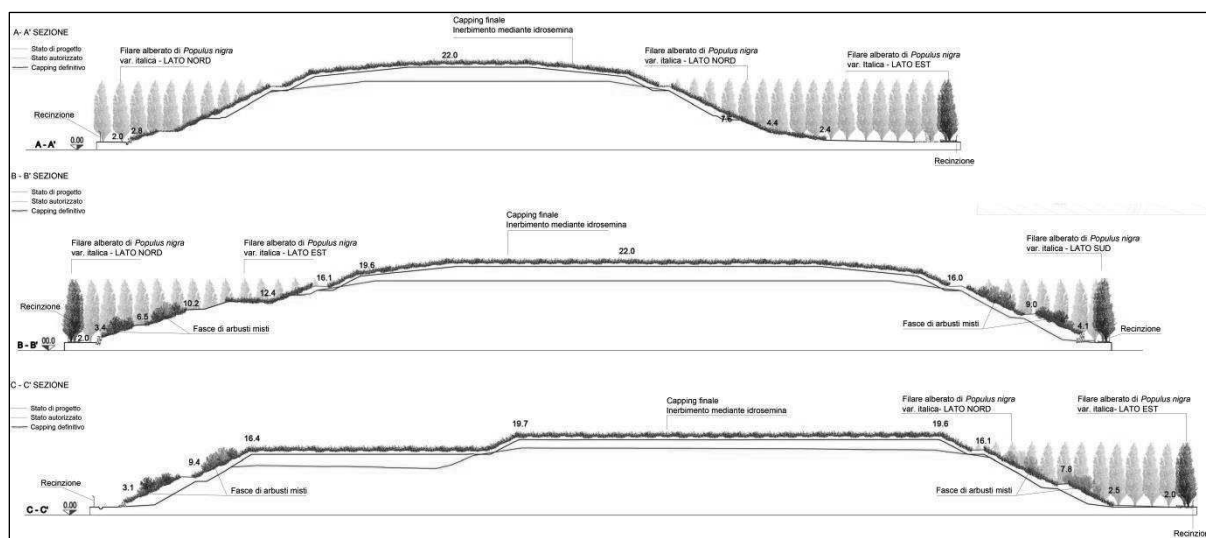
Estratto della Tavola P03-RA05 - Profili paesaggistici di progetto
